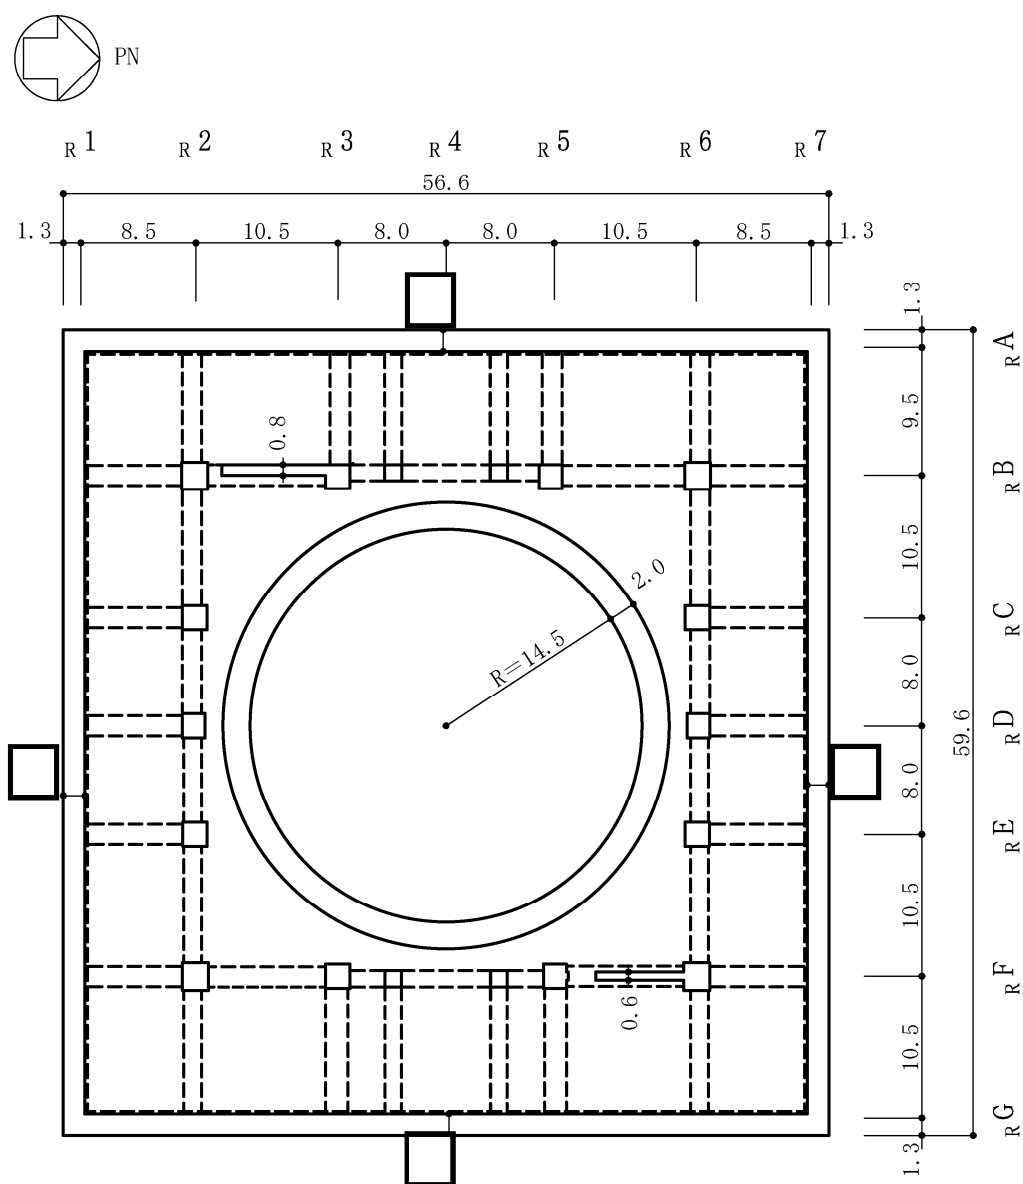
原子炉建屋の概略平面図 (B2F, T.M.S.L. -1.7m) (2/9) (単位: m)
